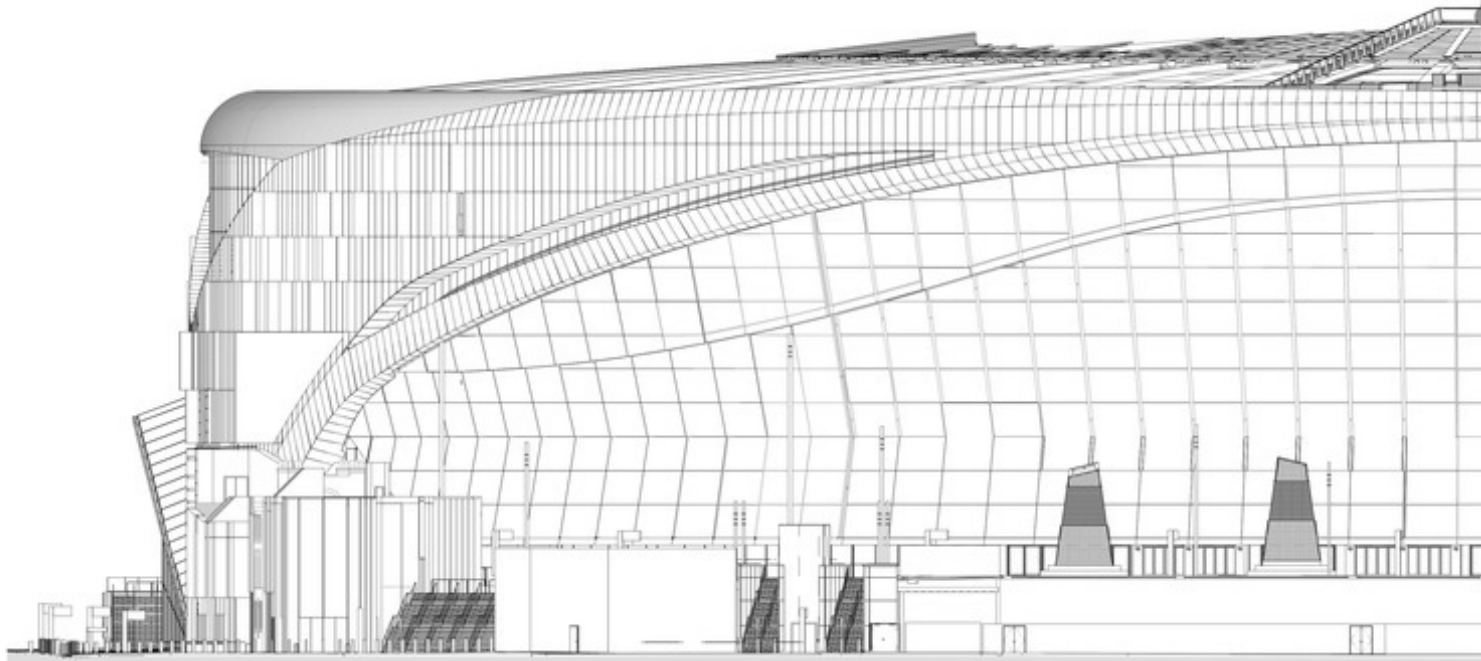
Detalle fachada sur, vidrio permeable y material ETFE.
